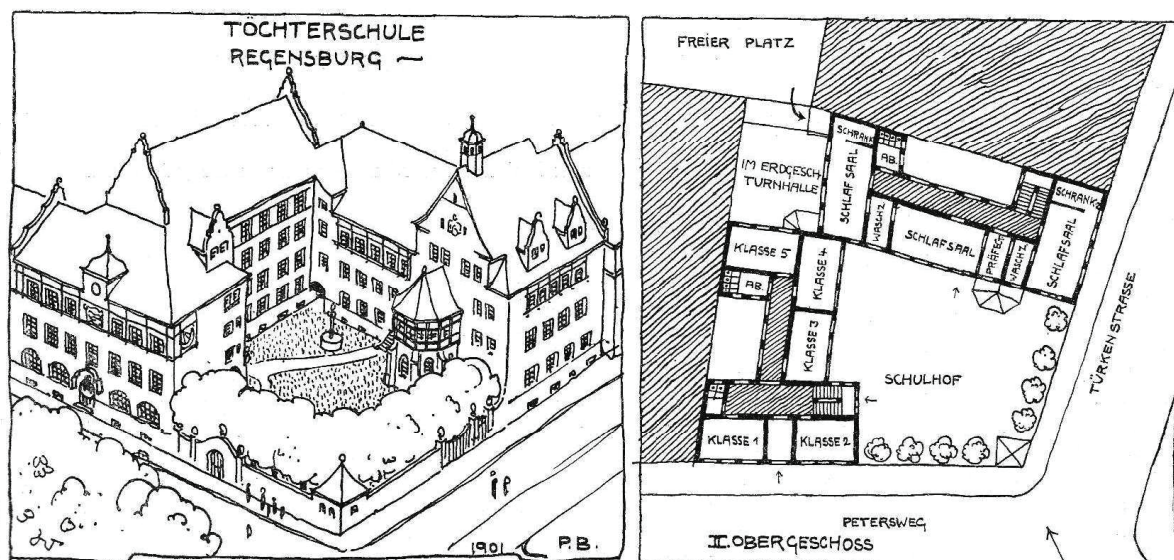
Wettbewerb-Entwurf Regensburg für eine Töcherschule mit Internat (Ansicht und Lageplan mit Grundriss): Architekt P.BONATZ, 1901 Eckgrundstück mit der Schule vorgelagertem Schulhof, der wird mit eine Baumreihe und einer etwa 2m hohen Mauer begrenzt. nördlicher Flügel Internat, südlich: Schule In: Das Schulhaus. 1902. 4. Jahrgang, No. 3. S.117, 121.
